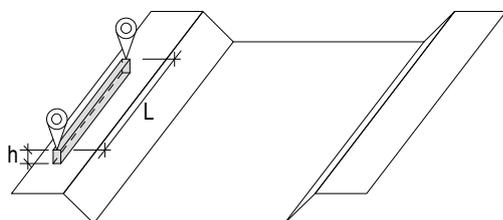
Schéma d'une paroi en bois (protection contre l'inondation / l'épandage d'alluvions).
